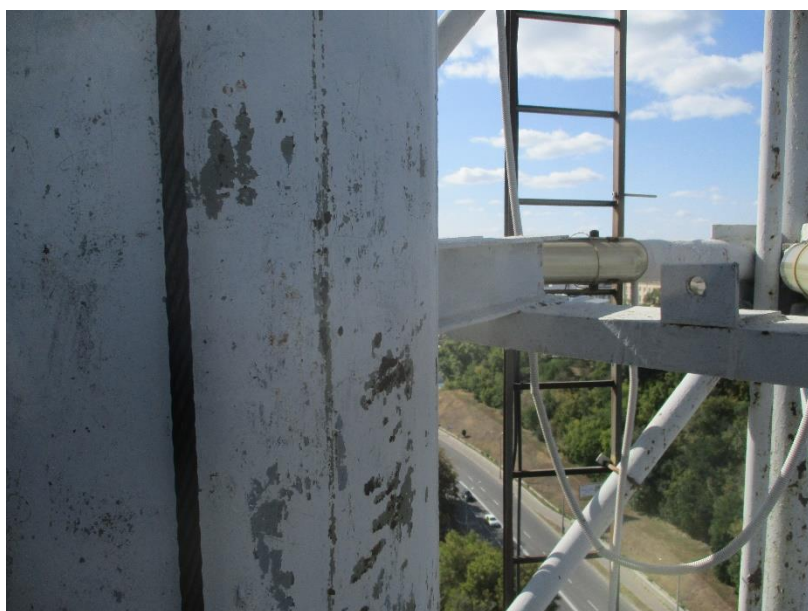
Металева обичайка, що фіксує нижній кінець щоглу в робочому стані не встановлена.
